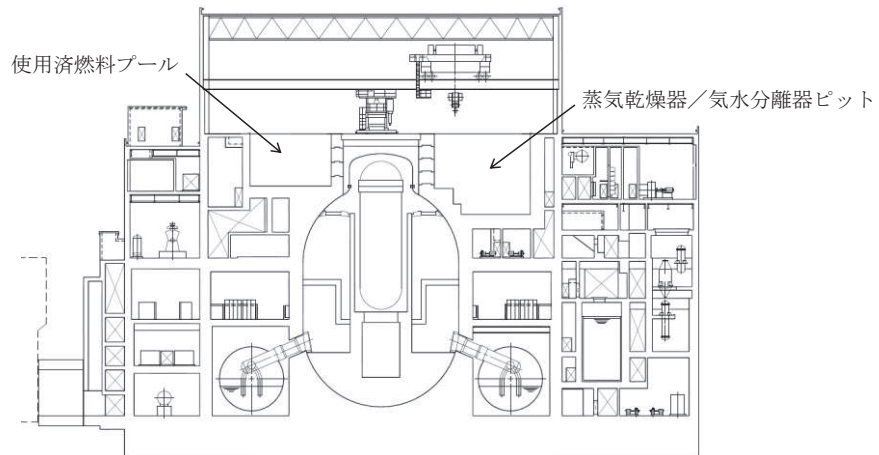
原子炉建屋の断面図 (EW 断面)
